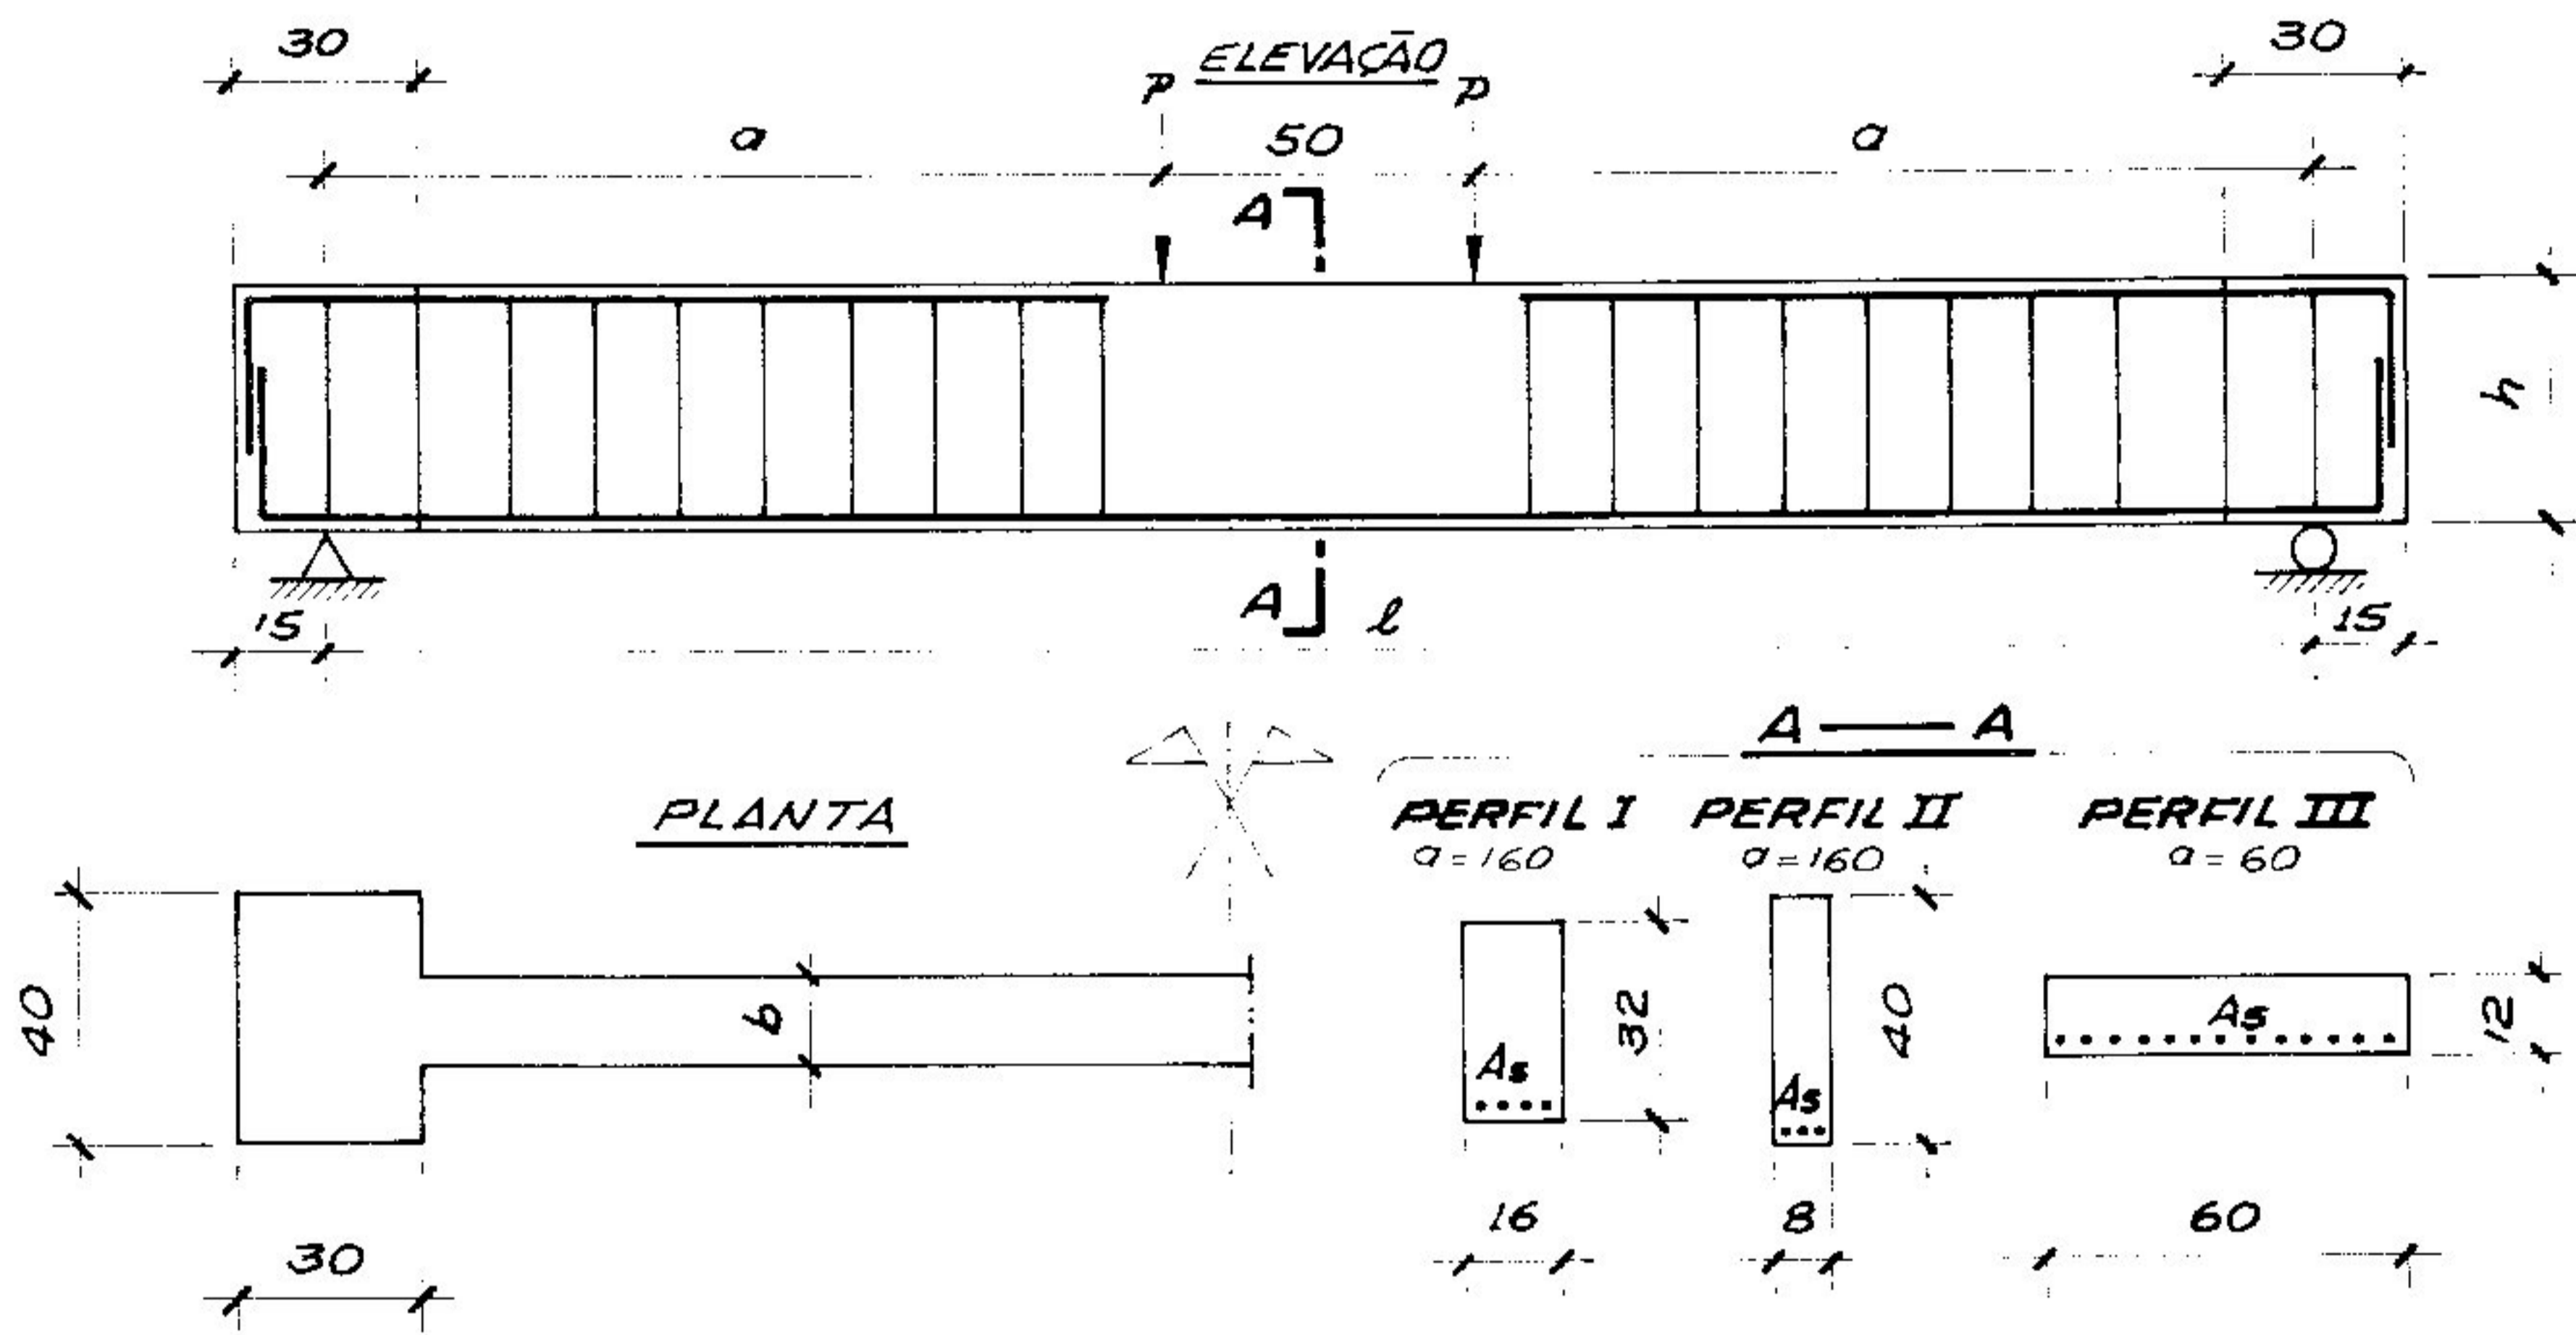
Geometria das peças ensaiadas e localização do carregamento.
